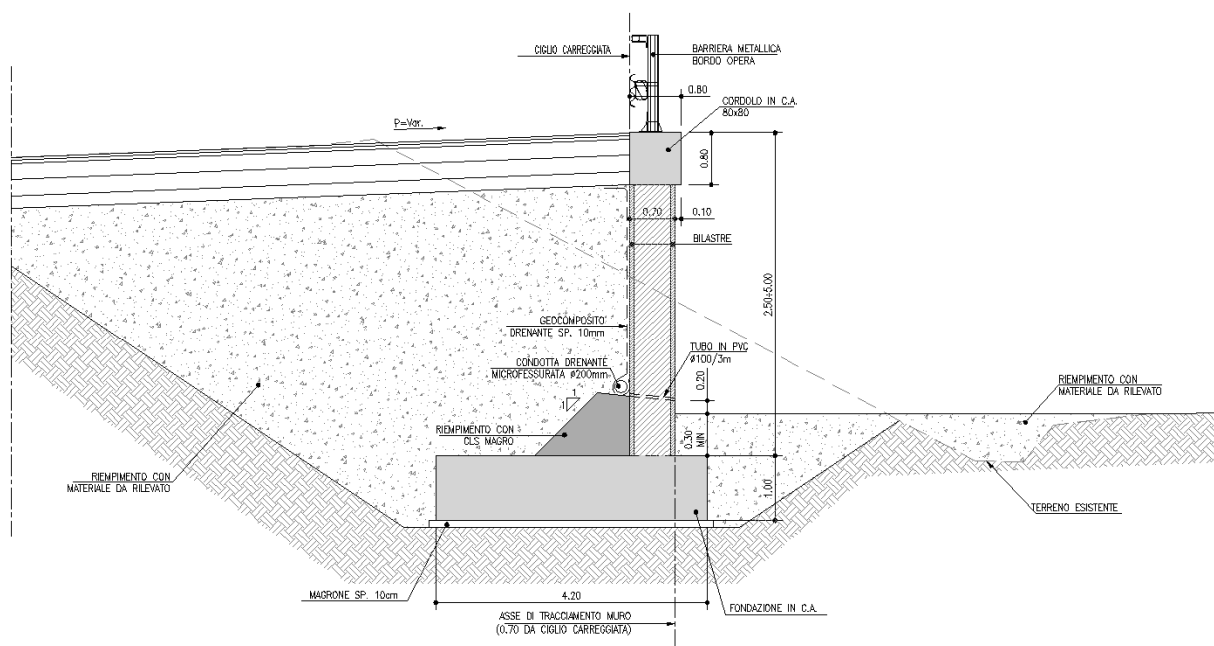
Sezione tipo opera di sostegno MS01 – Tratto a fondazione diretta
